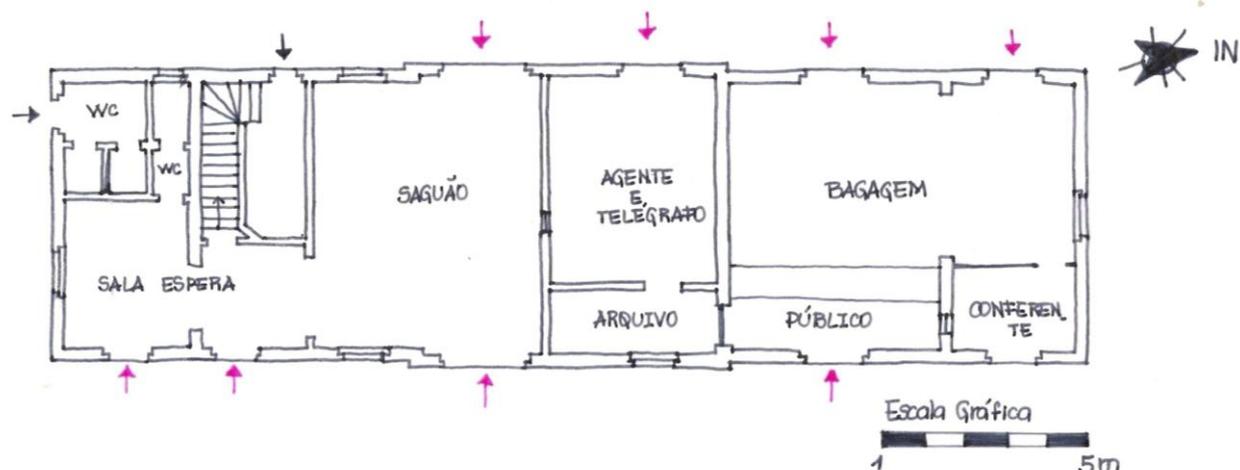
Planta baixa da edificação da Estação ferroviária de Santiago – Pavimento térreo.
